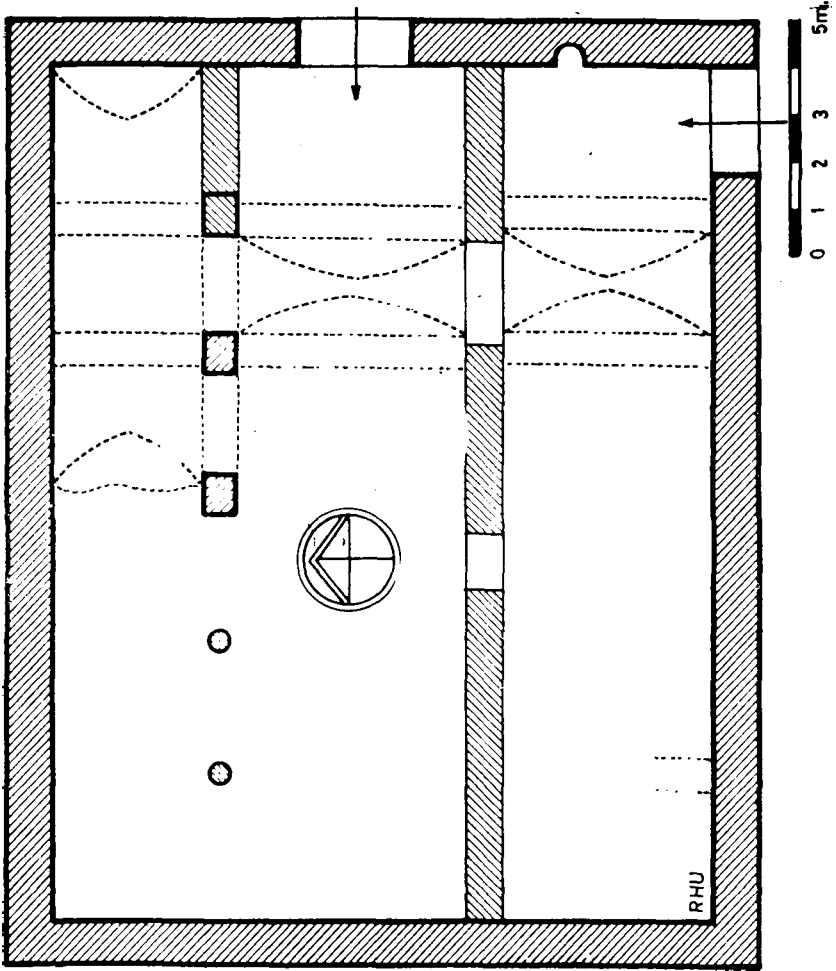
Pamuk Hanı (Divriği-Sivas). Plan.
